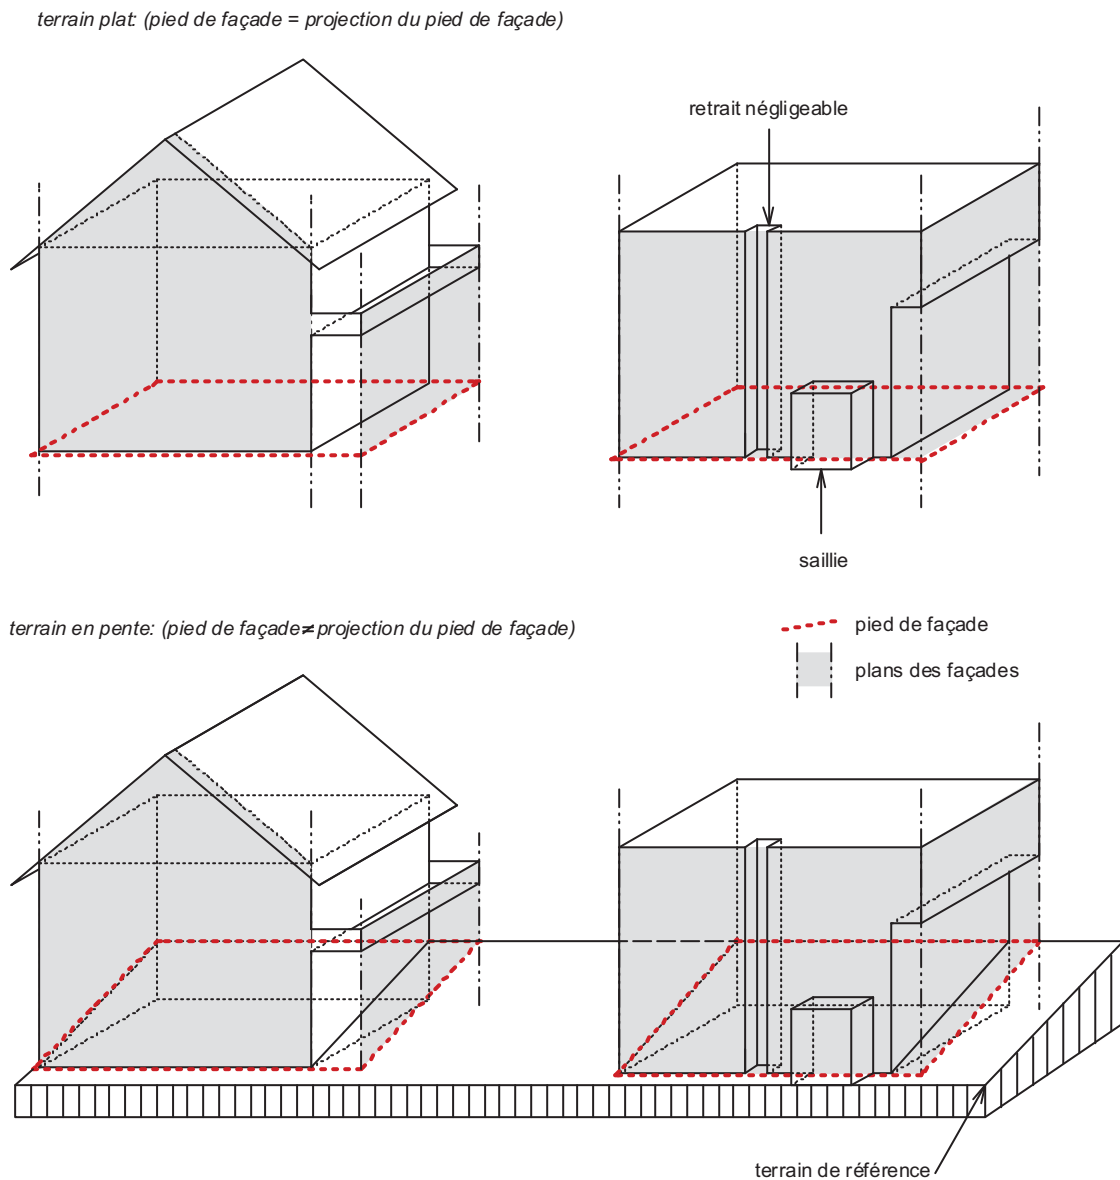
3.3 Plans des façades et projection du pied de façade
